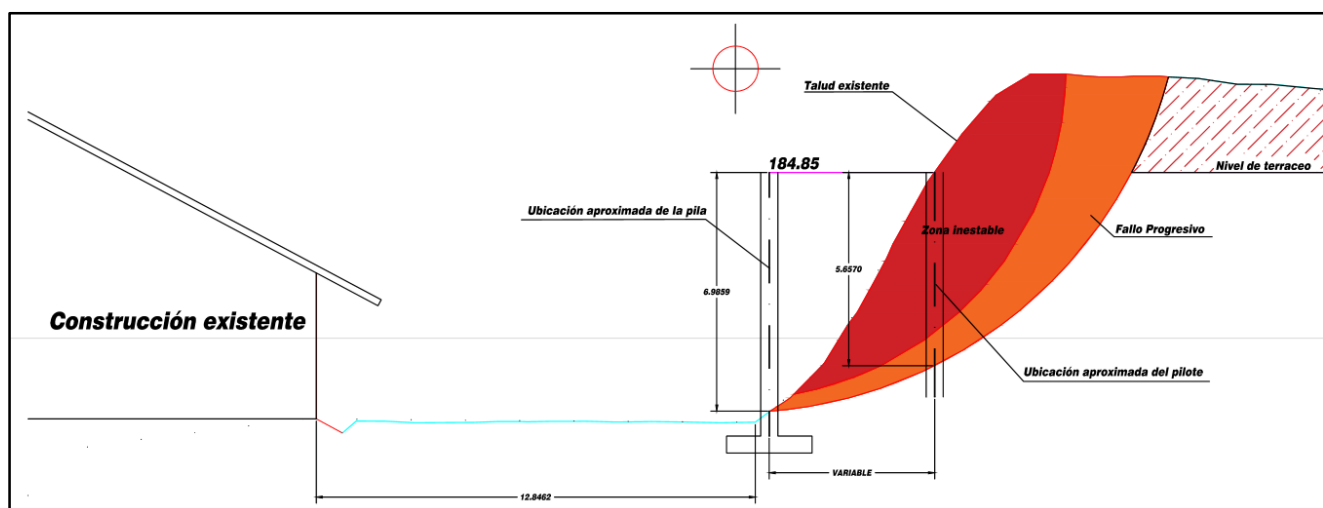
Ilustración sobre ubicación de pilas y pilotes en el perfil 6
